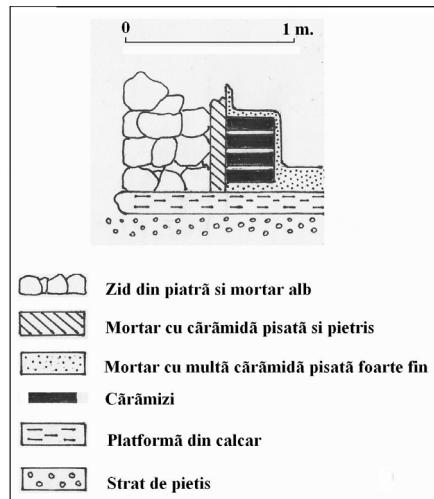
Structura peretelui vestic al construcției din caseta C1/2003.
